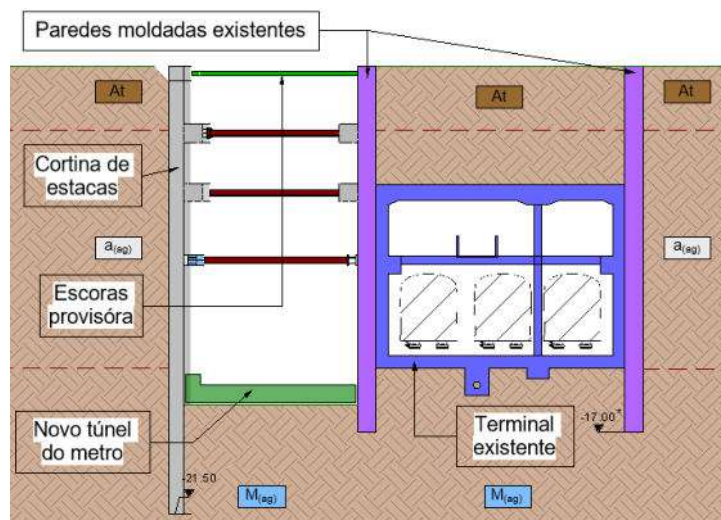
Corte Transversal da solução de Escavação em Cut & Cover
